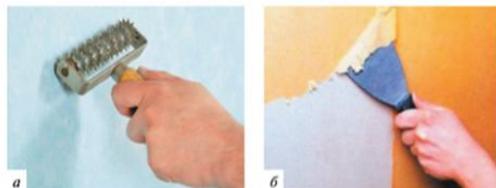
Инструменты и приспособления для снятия старых обоев: а — игольчатый валик; б — скребок-шпатель
